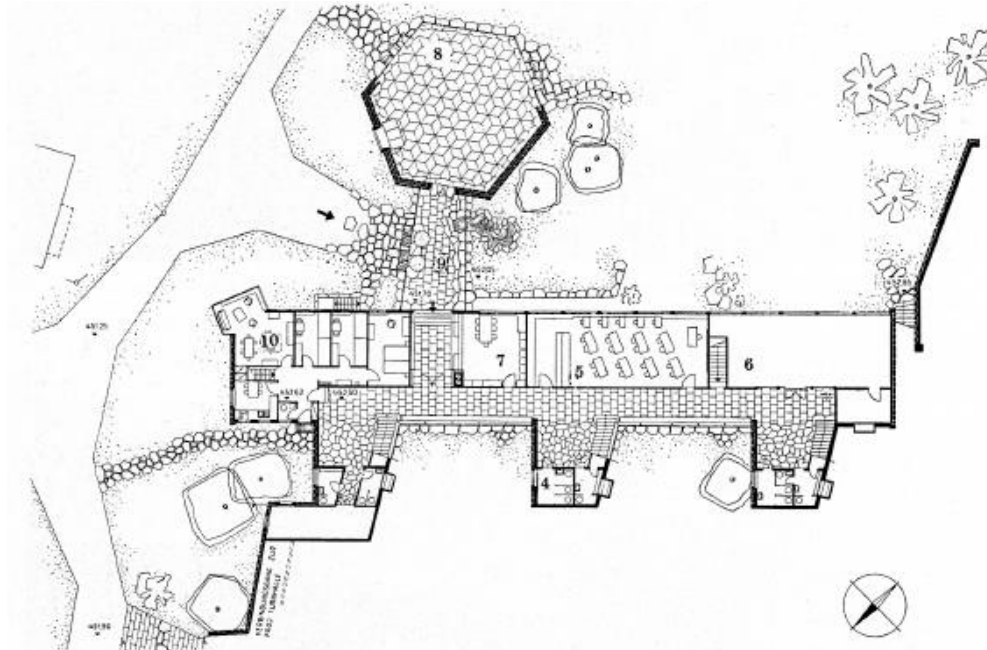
Planta baja del Matt Primary School. (Roth 1950, 126)
